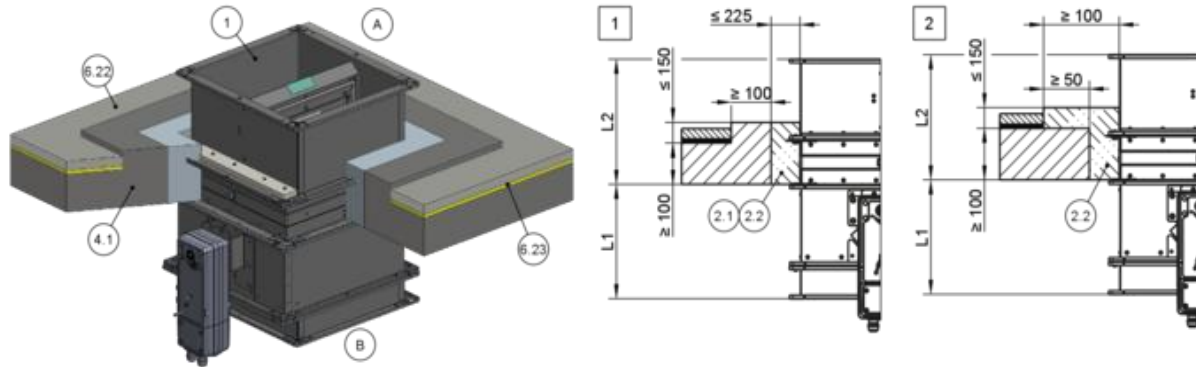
Nasseinbau in Massivdecke mit Estrich und Trittschalldämmung, hängend
